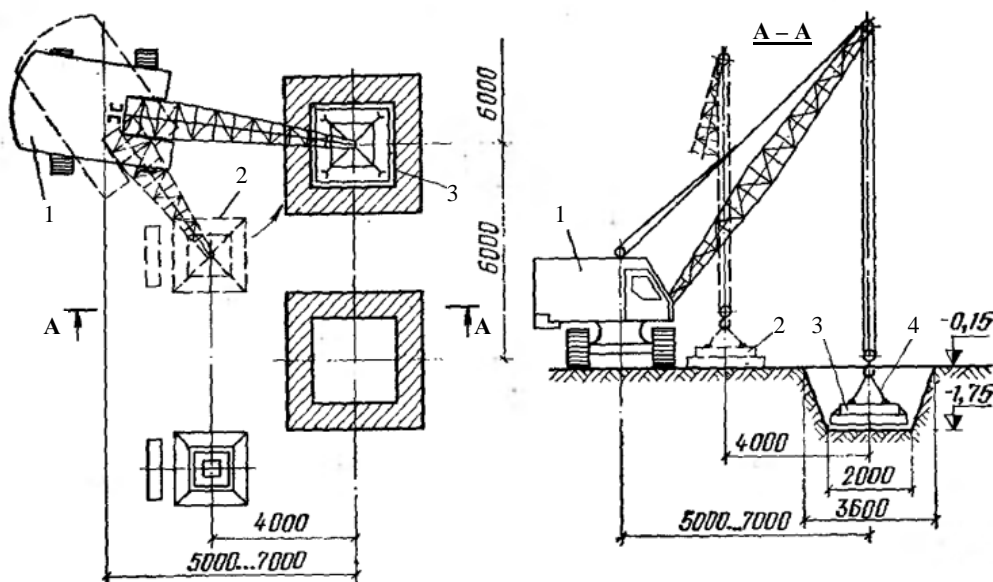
Схема монтажу фундаменту стаканного типу: 1 – гусеничний кран; 2 – положення блоків фундаментів до піднімання; 3 – блок фундаменту на проектній позначці; 4 – чотиригілковий строп
